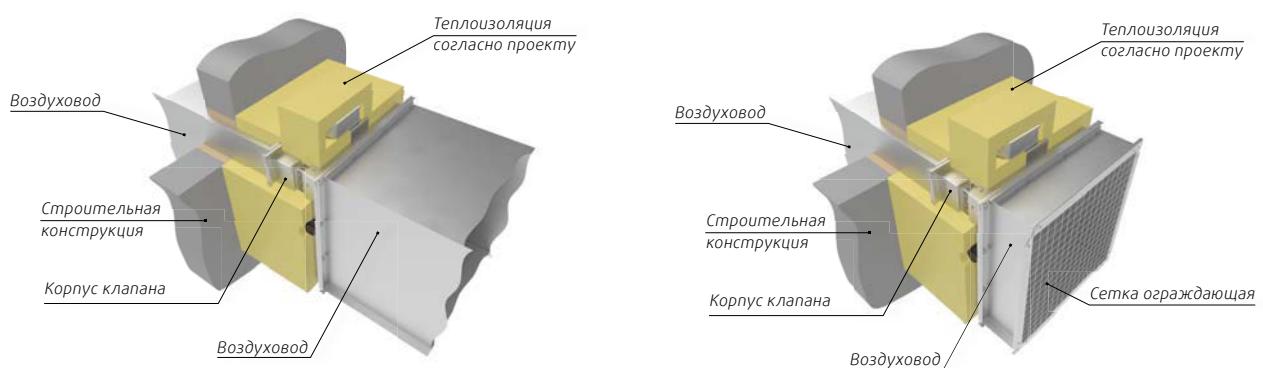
Схема монтажа канального клапана прямоугольного сечения вне проема строительной конструкции
